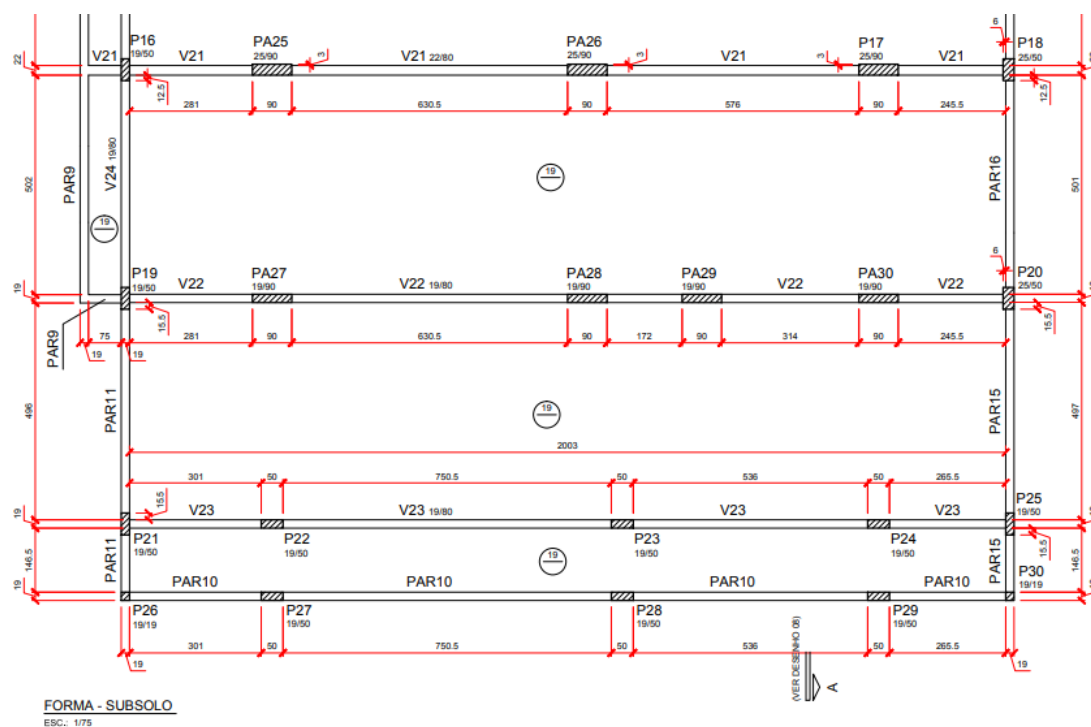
Parte de planta de fôrma do subsolo de uma edificação, com cotas e nomenclatura de vigas, pilares e paredes. (Fonte: <http://galeriadeprojetos.altoqi.com.br/galeria/edificio-residencial-vitra/> projeto de Maria Filho et al.)
